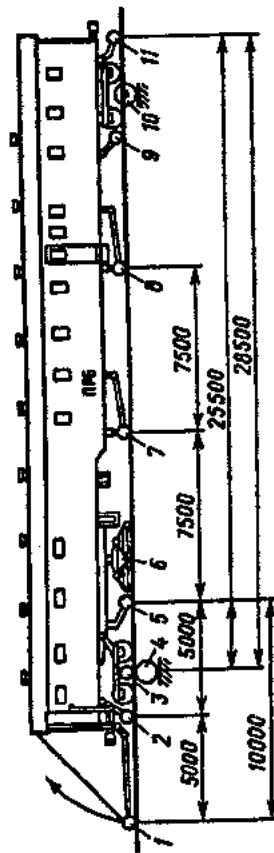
Путирхтовочная машина Балашенко ПРБ: 1, 2, 5, 11 — концевые тележки стрелограрфов; 3, 5, 7 — измерительные тележки стрелограрфов; 4 — уплотнительный каток; 6 — сдвигающее устройство; 9 — магнитный регулятор; 10 — пуг
